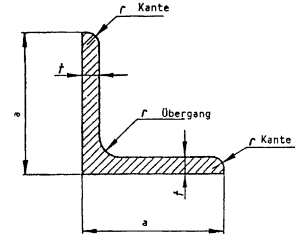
Gleichschenklige Winkel, DIN EN 10056-1
